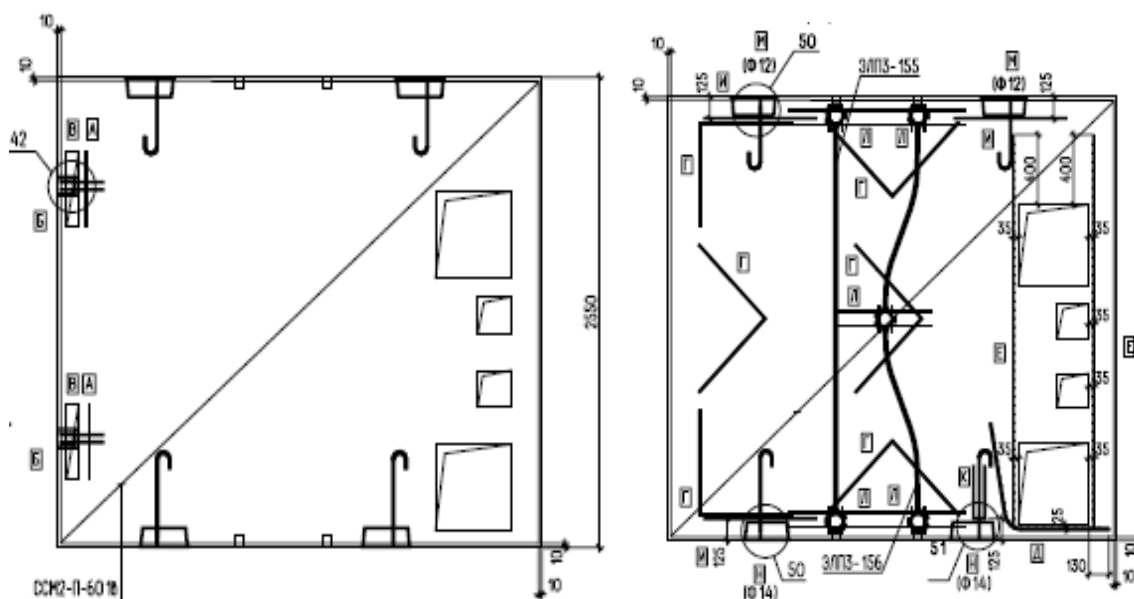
Пример армирования ж/б плиты в ПК «AllPlan»
